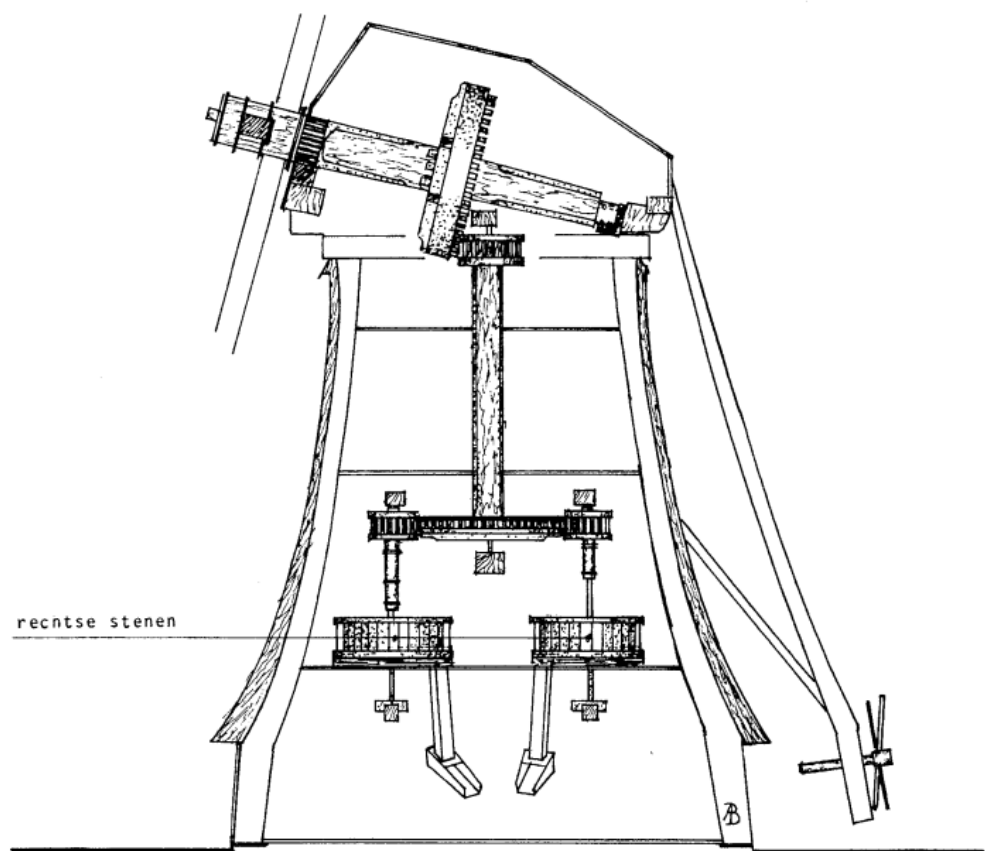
AANDRIJVING STENEN VAN BOVENKRUIER
